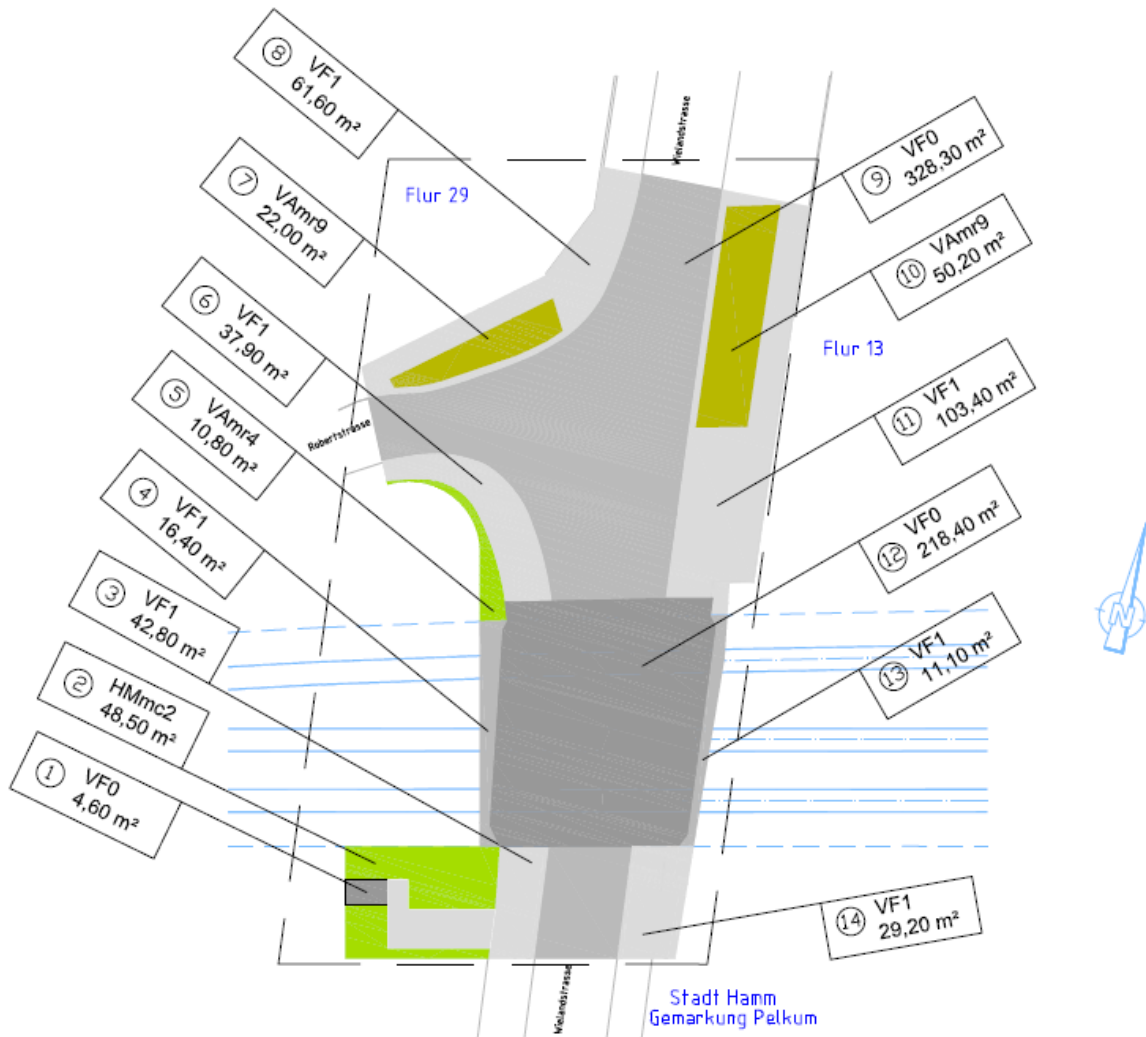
Art und Lage der Biotoptypen nach Umsetzung der Planung (Planzustand)
